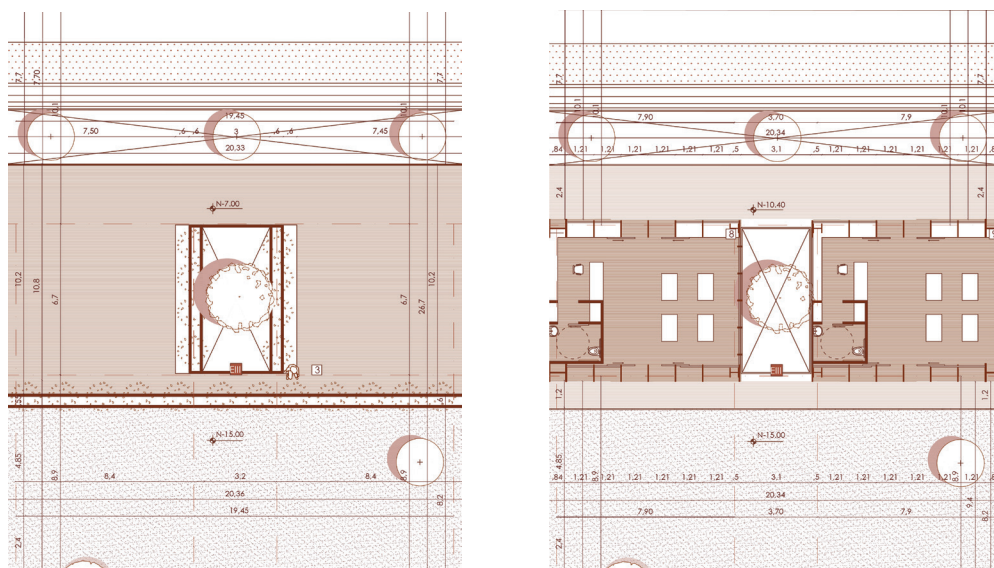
Bloque de enlace. Planta de cubierta N-2.47. y Planta N-10.40
